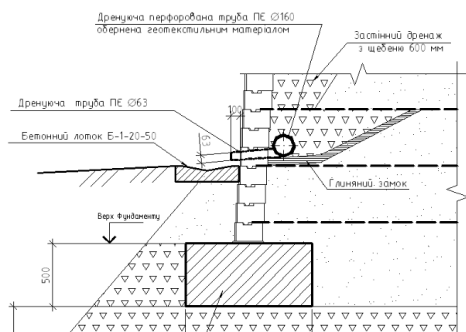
Схема отвода воды с конструкции подпорной стенки
